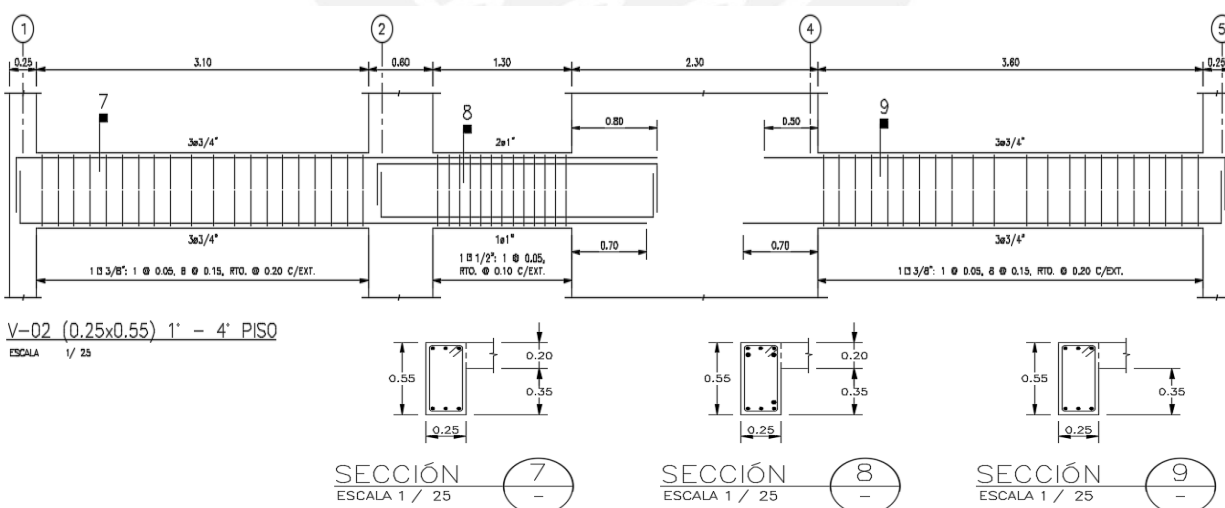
Esquema final de armadura de Viga V-2 (0.25x0.55) del 1° al 4° piso
